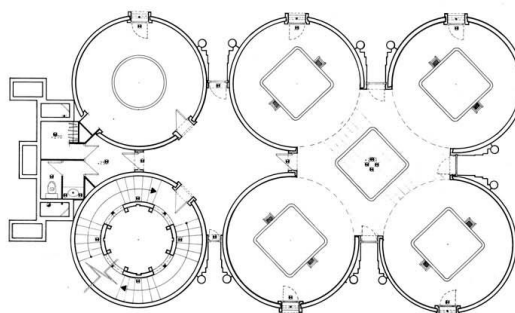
Arquitectura de Uso Mixto Imagen y planta de la Reconversión Sant Just Desvern (2012) Fuente: Courtesy of Ricardo Bofill
